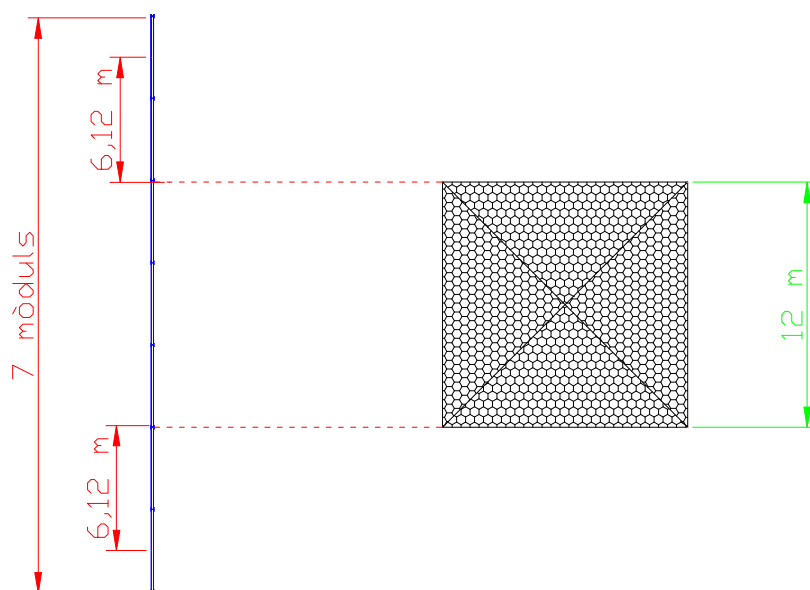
Croquis vista planta situació pantalla respecte R8.
